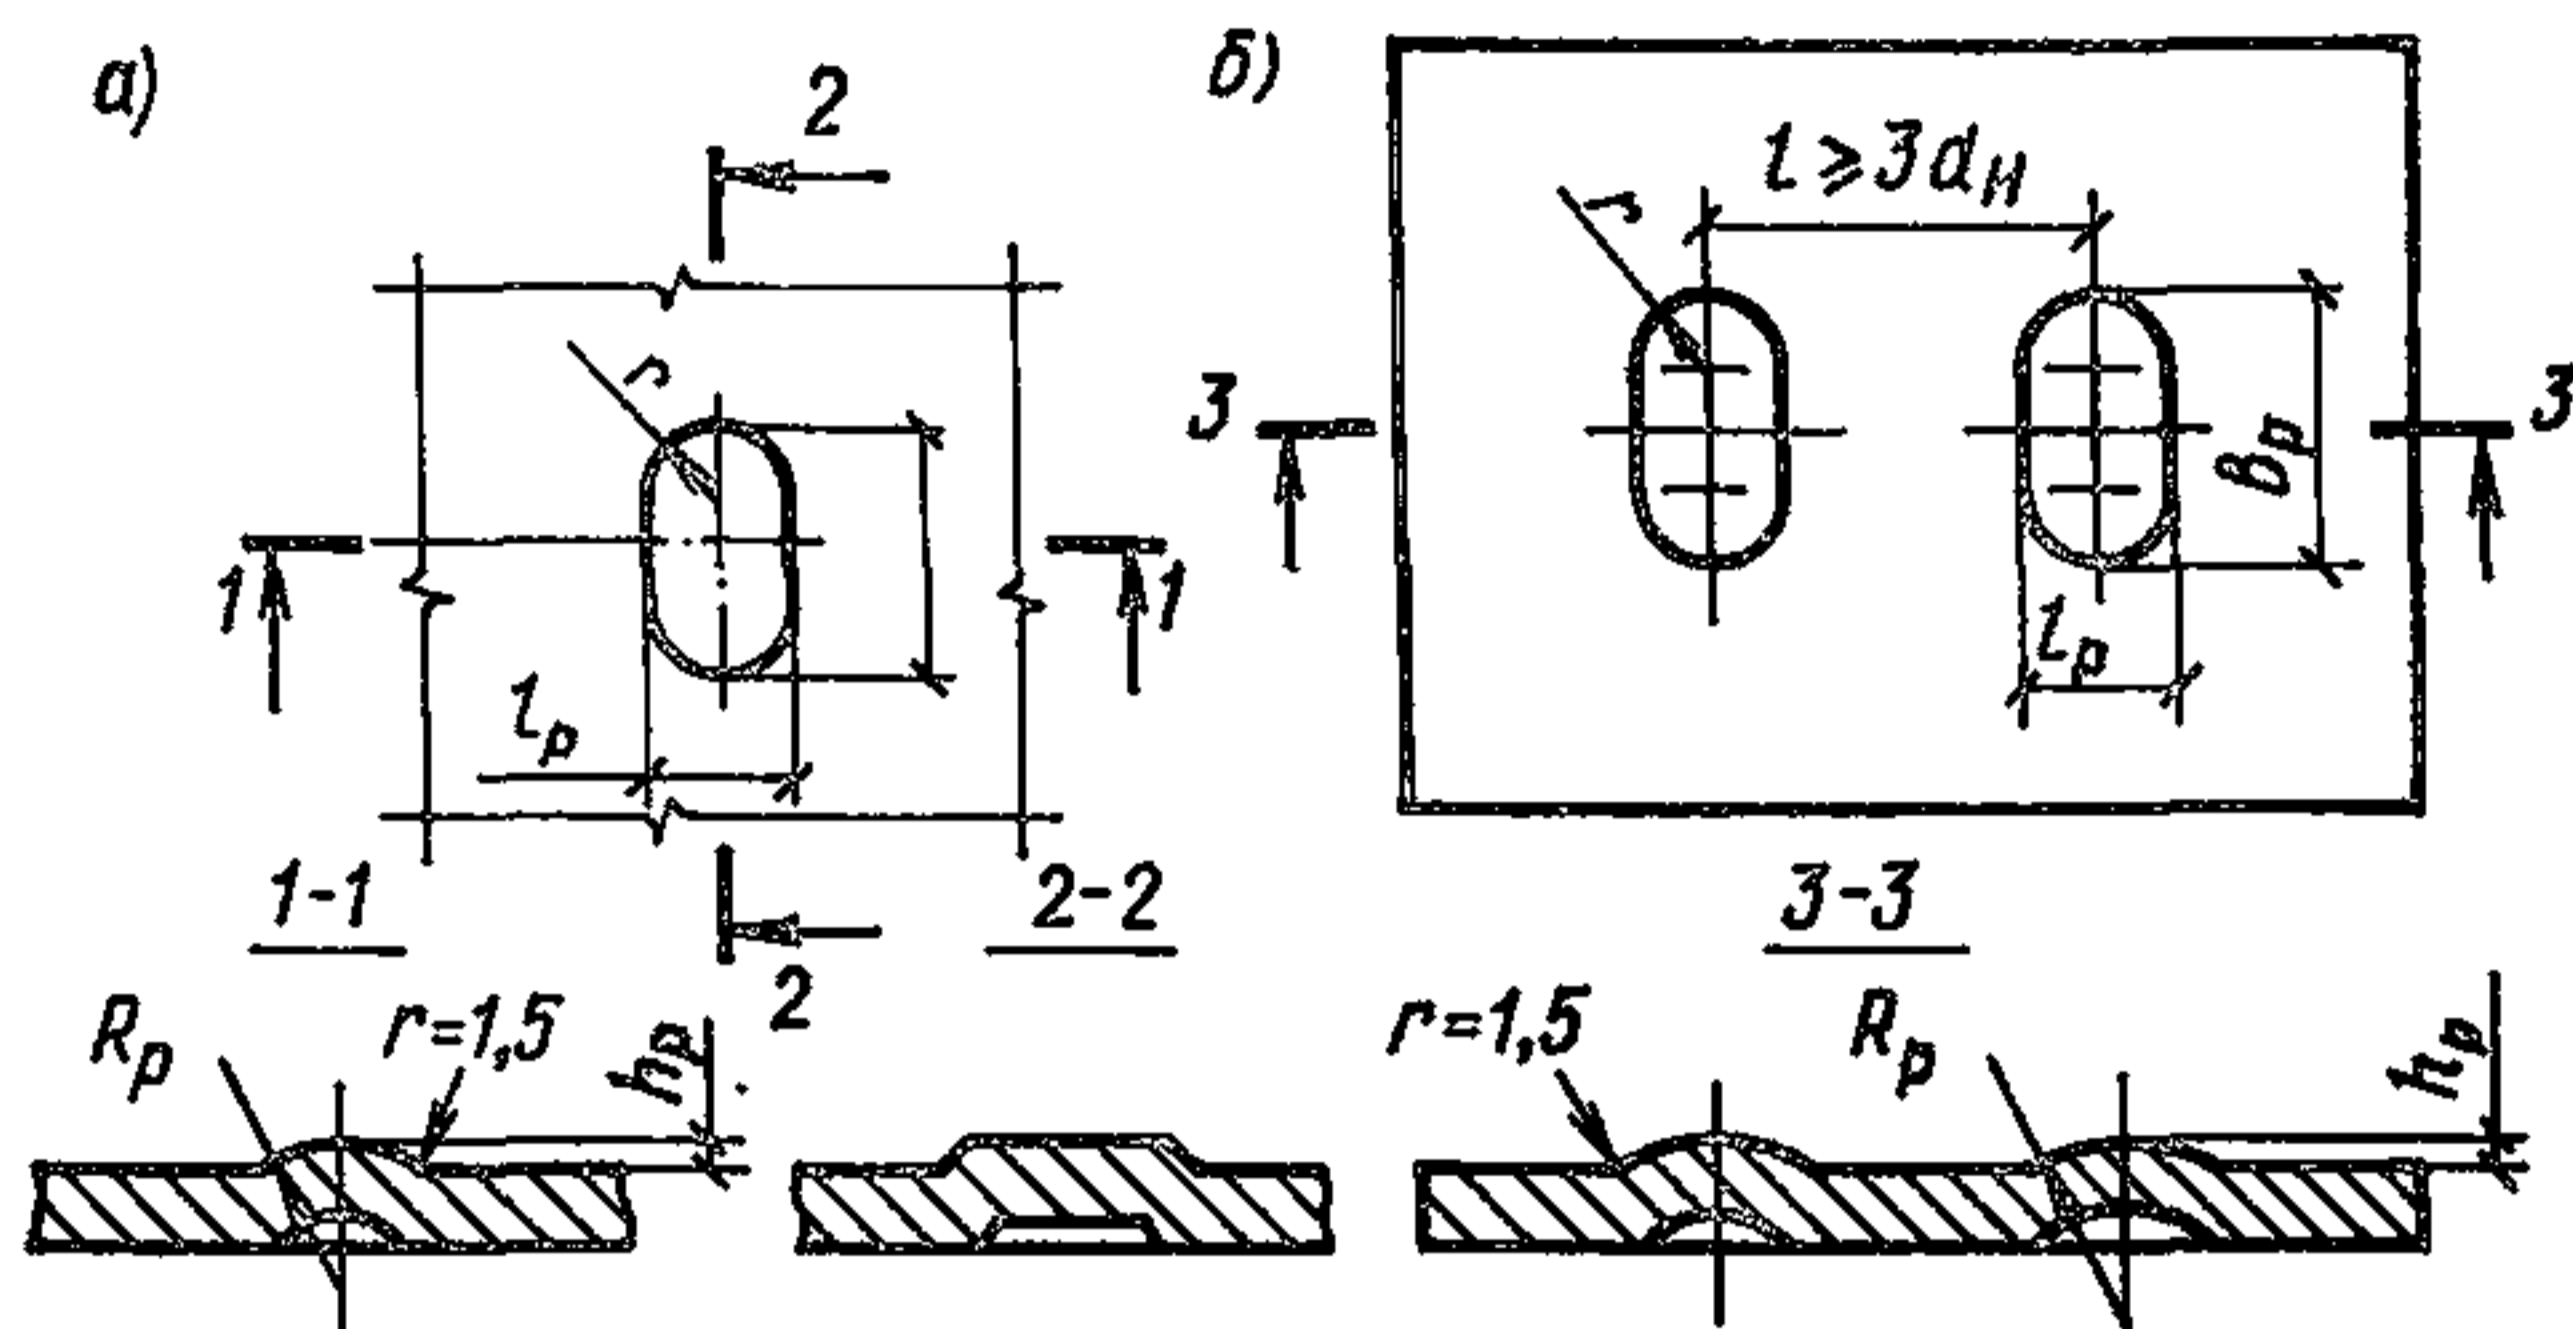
Параметры рельефов нахлесточного соединения закладной детали для сварки стержня с плоским элементом
